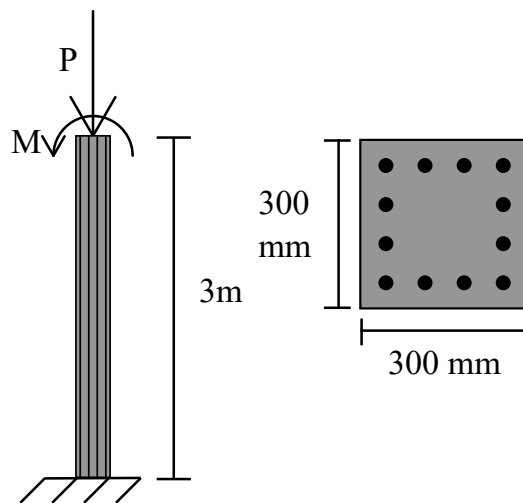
Coluna sujeita a carregamento excêntrico e detalhamento da seção transversal
